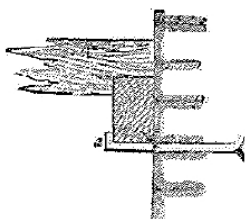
Elemento metálico em Consola (Segurado [17])
